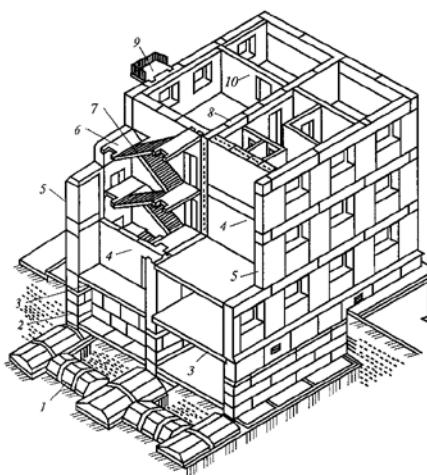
Конструктивная схема крупноблочного здания с продольными несущими стенами: 1 – фундамент; 2 – стены подвала; 3 – перекрытия; 4 – внутренние стены; 5 – наружные стены; 6 – лестничная площадка; 7 – лестничный марш; 8 – внутренняя продольная стена; 9 – балкон; 10 – межкомнатная перегородка
